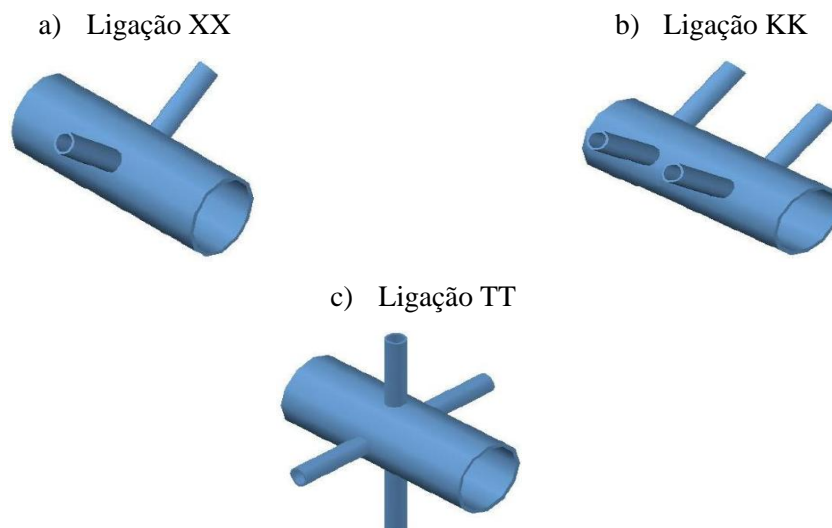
Ligações tridimensionais soldadas entre barras tubulares.
